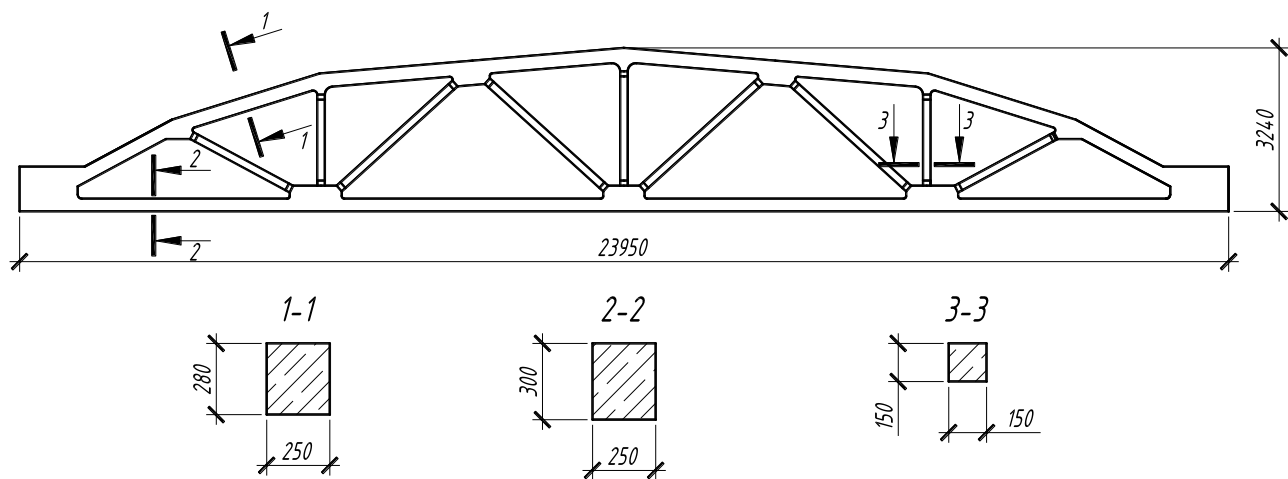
Ферма кров'яна залізобетонна сегментна 2ФС24-3К7
